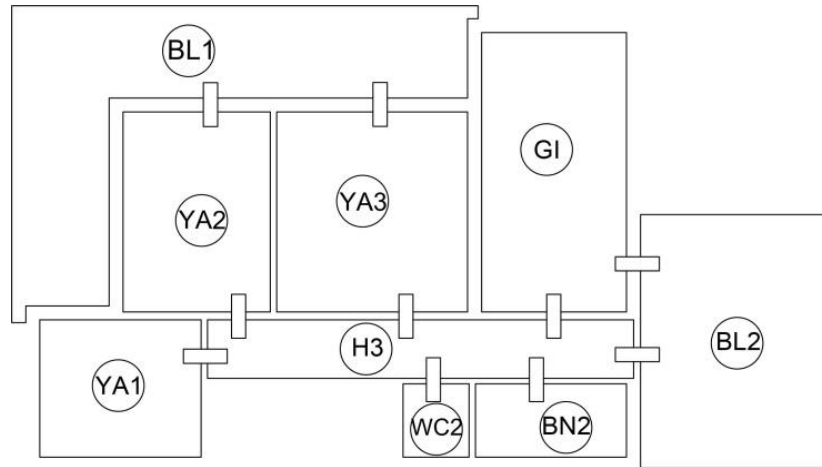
Dr. İhsan Sami Evi giriş kat planı
